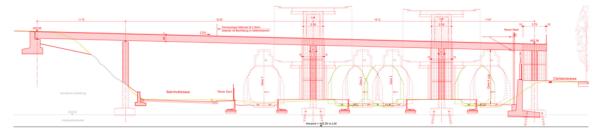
PUe Bahnbrüggli, Längsschnitt.
